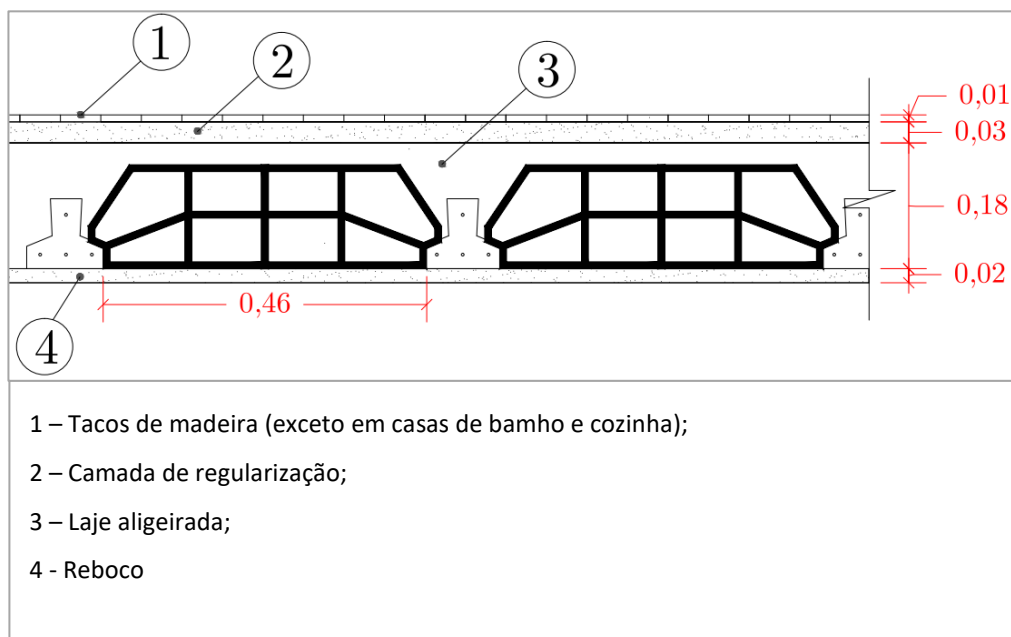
Laje aligeirada com abobadilhas e vigotas pré-esforçadas.
